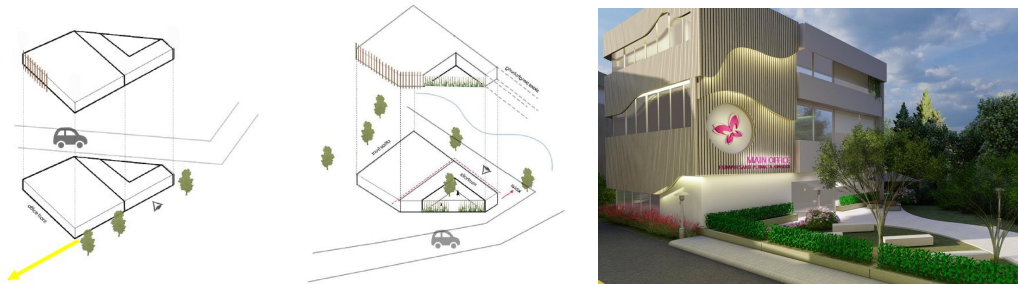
Bentuk Bangunan dan fasad gedung a
